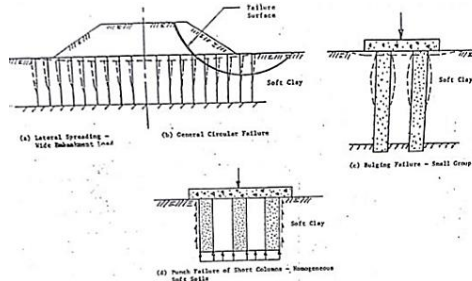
12 Tipe keruntuhan Stone Column tunggal
